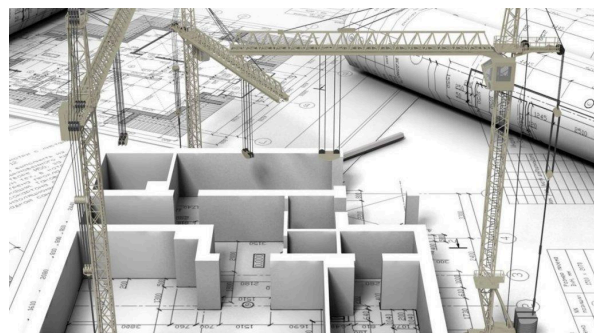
Plano de Casa en Construcción (Fuente: arquinetopolis, 2025)
